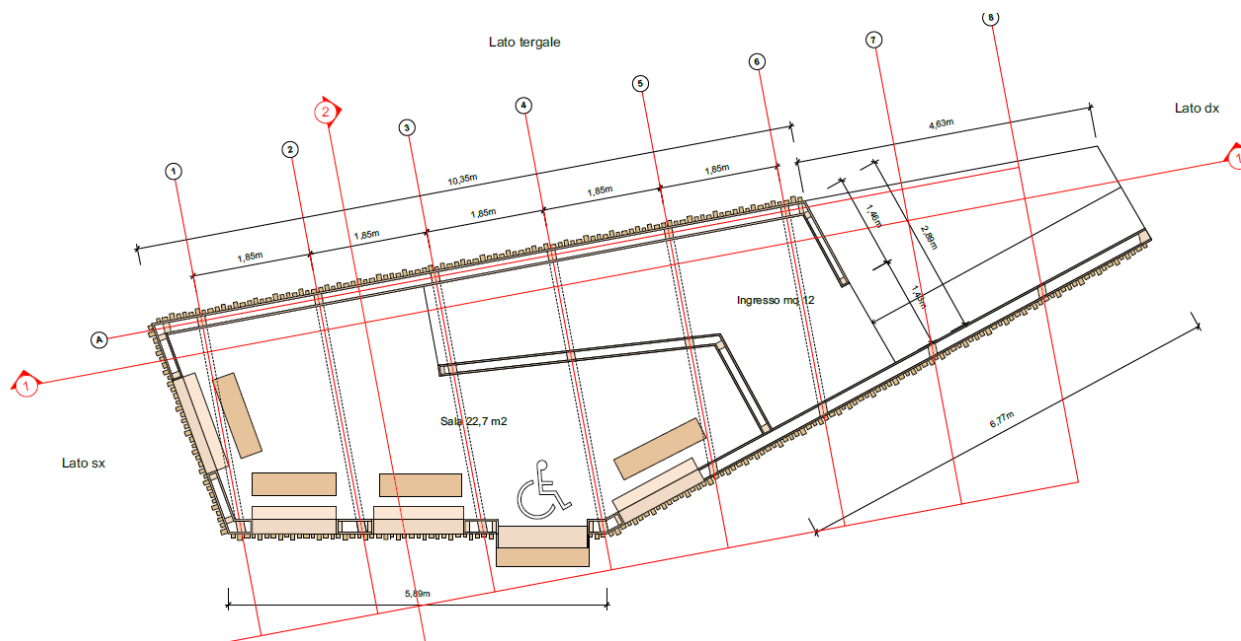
Pianta dei locali degli osservatori (estratto el. FLR-MPL-PSA-CAP4-029-AR-DG_Manetti Oss Plan Ele Sez)
